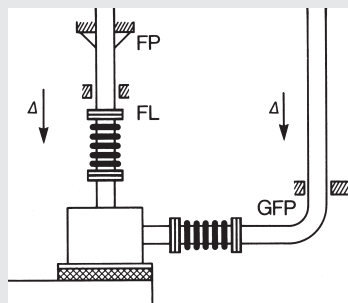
Осевой компенсатор, соединенный с вибрирующим агрегатом. Направляющие опоры и крепления.
